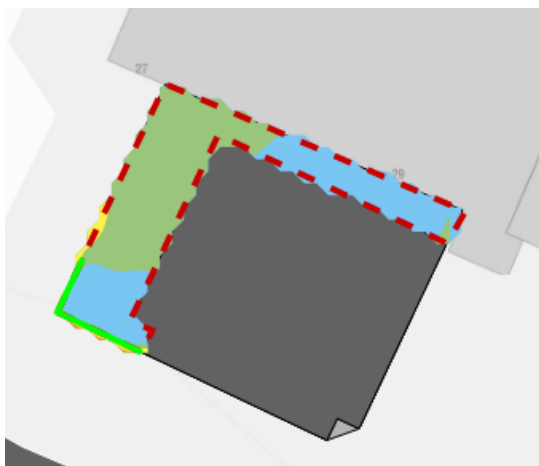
Åtgärder för ljudnivå vid fasad plan 11
